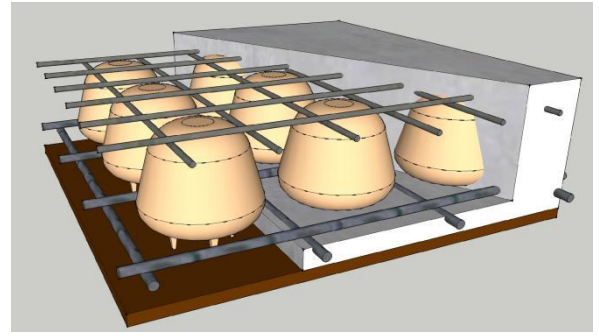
Фрагмент конструкции перекрытия с заменой части тяжёлого бетона вкладышами из пластмассы
